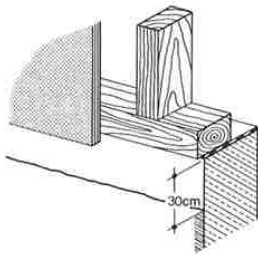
Paroi en bois posée sur un socle massif: traverse en saillie située au minimum à 30 cm du sol (projections d'eau) et posée sur une couche isolante; jet d'eau sur la face extérieure (lambrissage de bois, panneau d'aggloméré, plaque d'amiante-ciment, tôle ondulée trapézoïdale, etc.).
